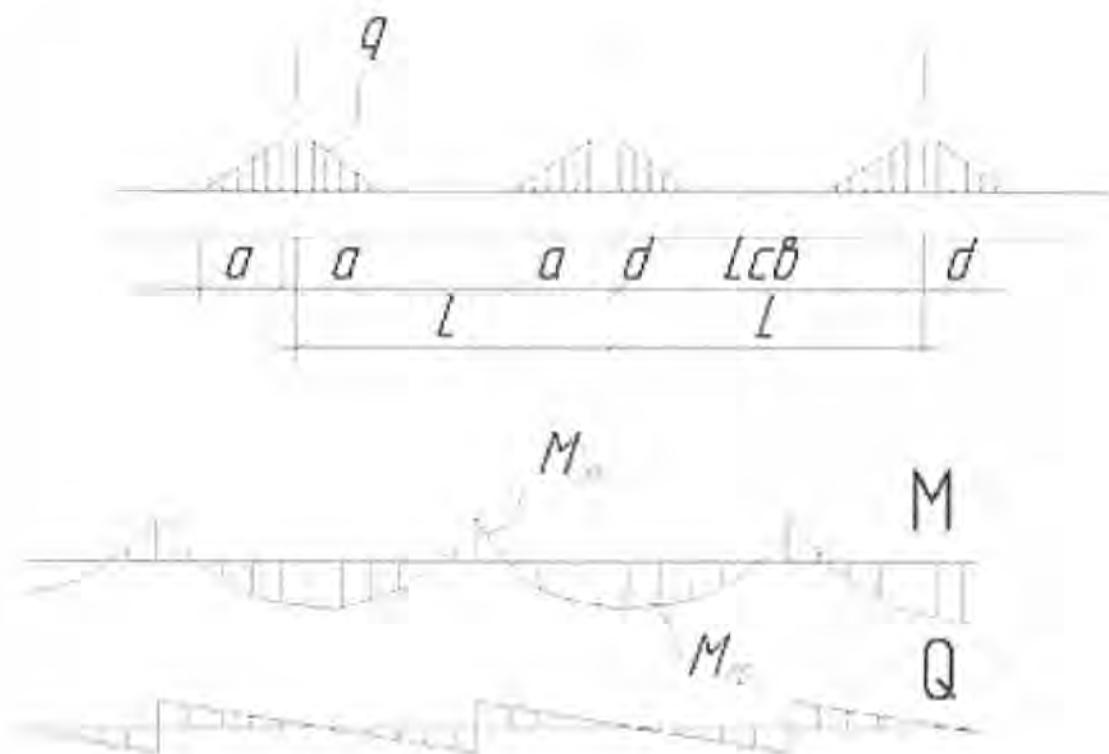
Расчетная схема ростверка и эпюры усилий
